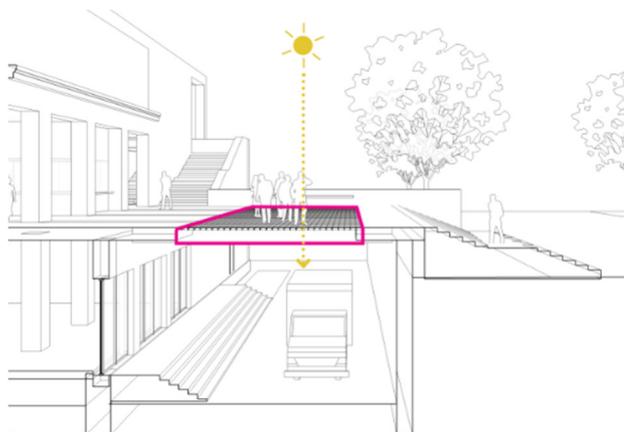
Схема расположения светопрозрачного фрагмента перекрытия [1]
